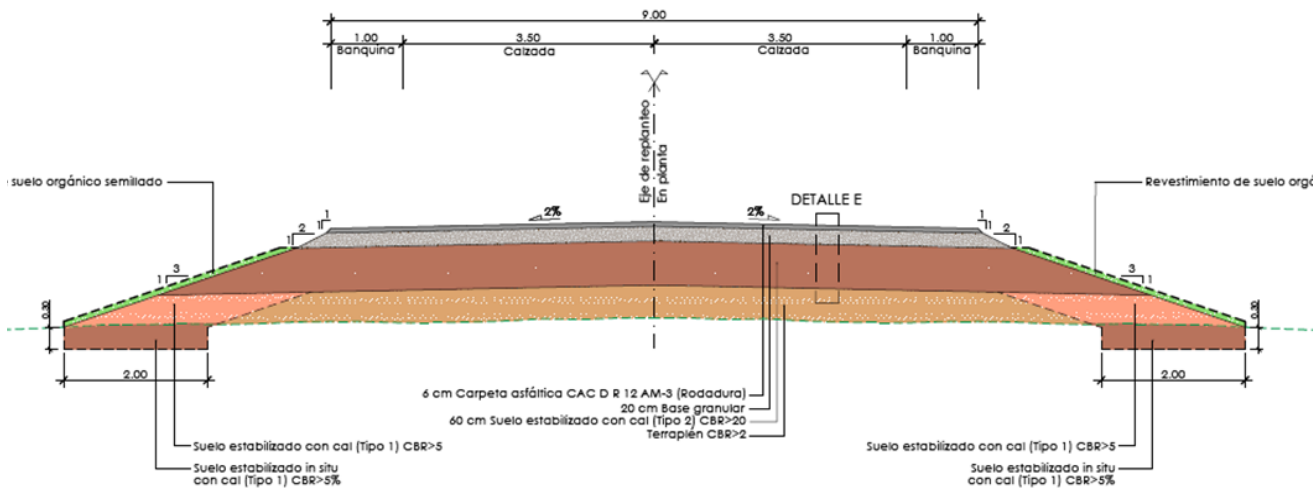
Sección tipo de obra básica y estructura de pavimento, Ninfa
